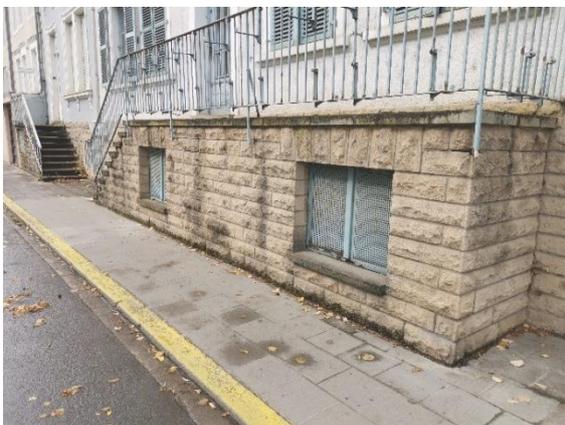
vue des éléments à supprimer sur le trottoir donnant sur la N.10 (Source : Best)
